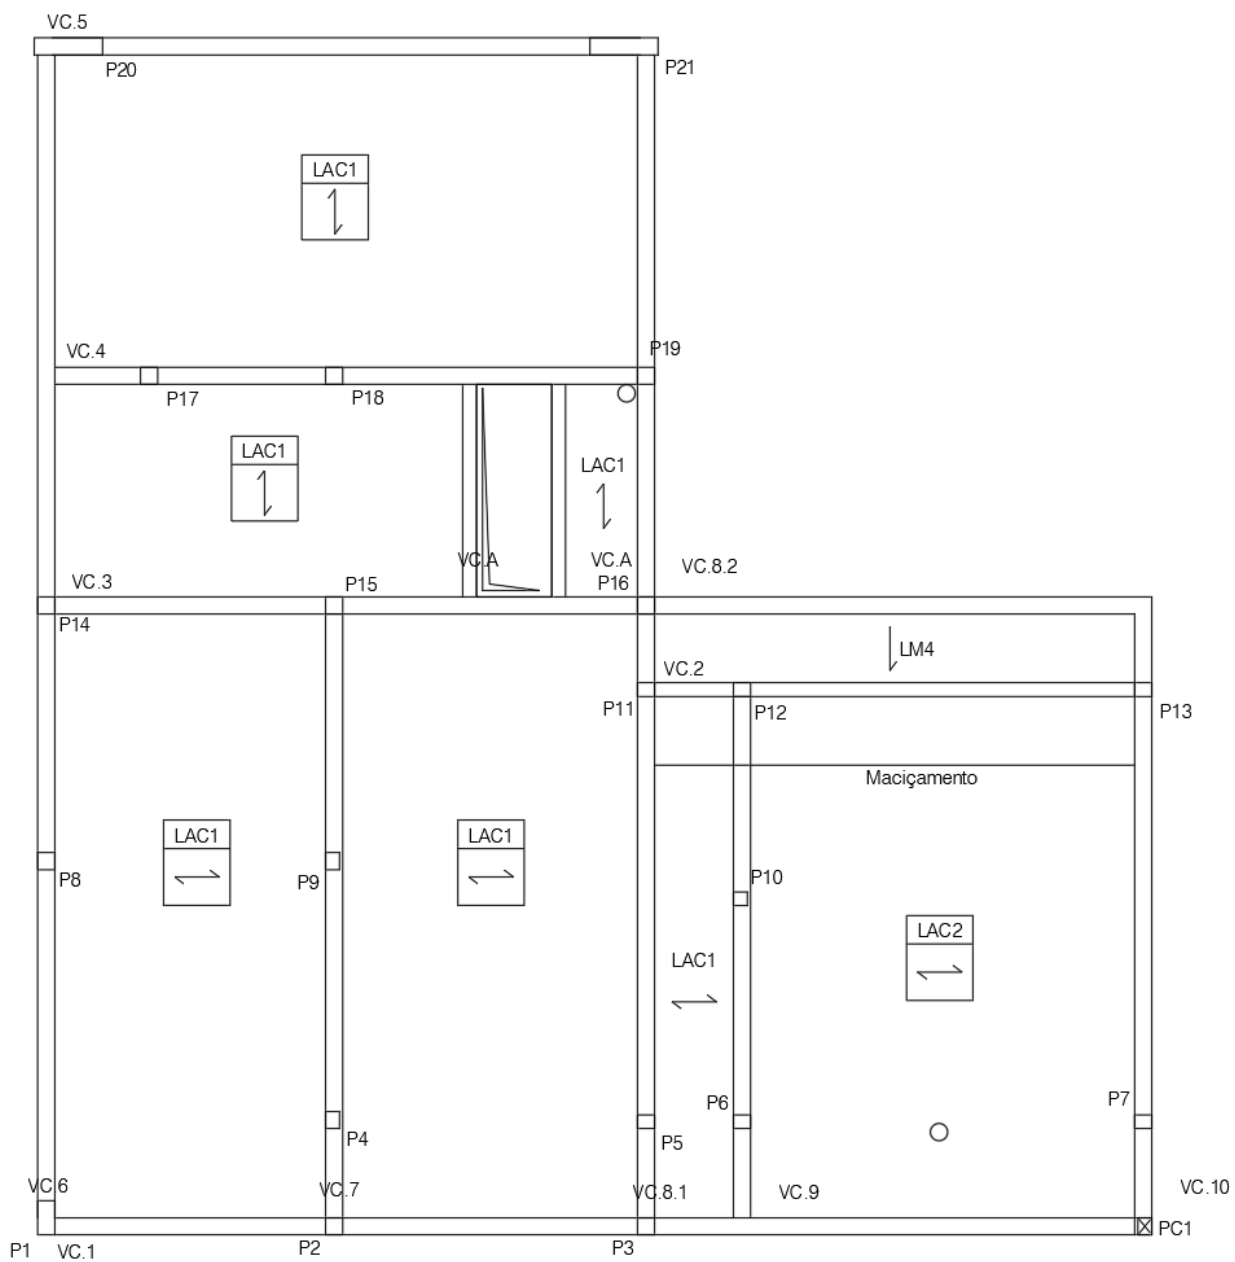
Esquema estrutural da cobertura (Projeto de estruturas).
